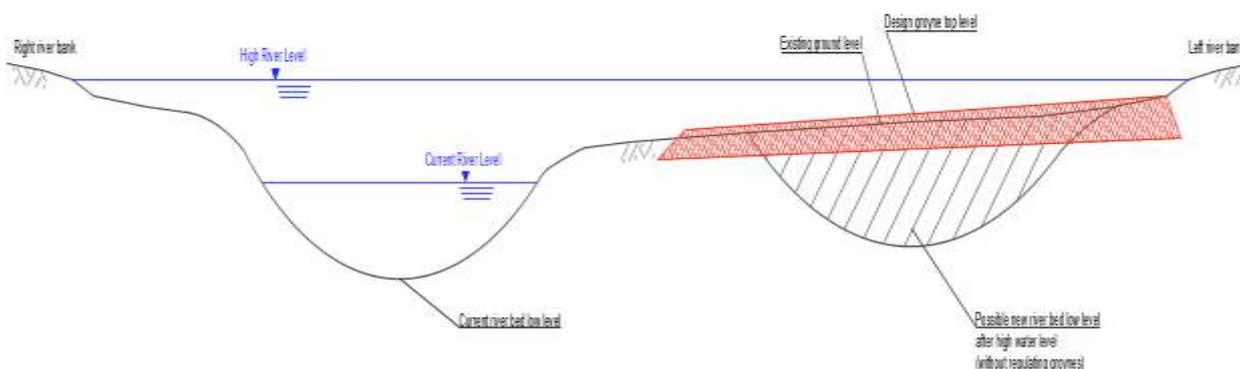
PERFIL TRANSVERSAL DA SECÇÃO DO RIO
